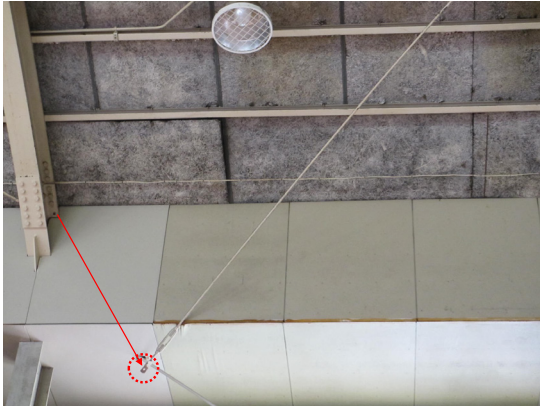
屋根面水平ブレースボルト破断と垂れ下がり
